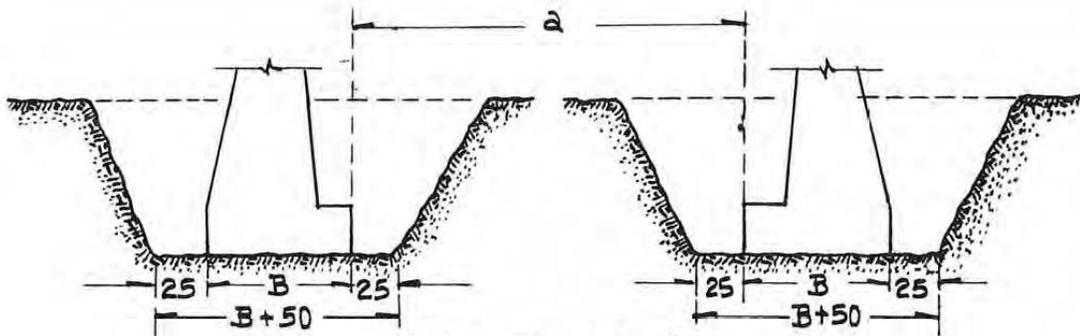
EXCAVACIÓN PARA ESTRIBOS EN LOSAS
